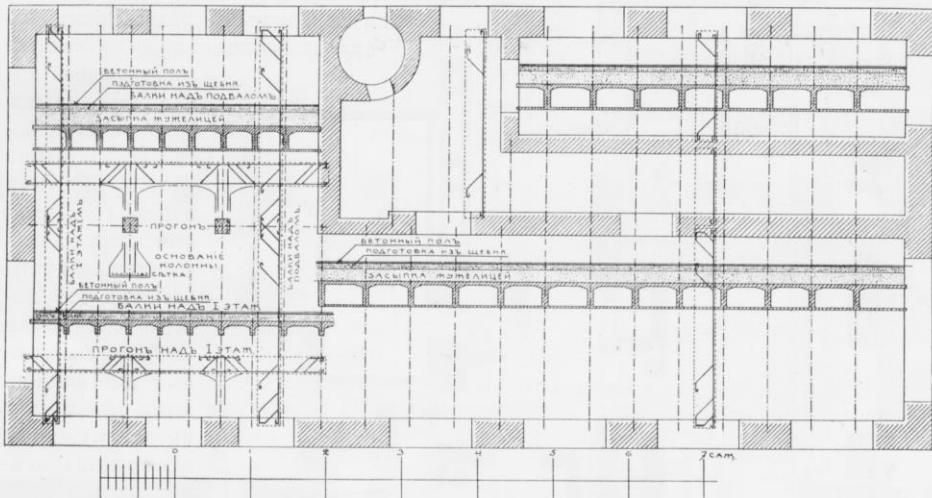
Подвалъ Станції. Желѣзо-бетонная конструкція перекрытия подвала.
